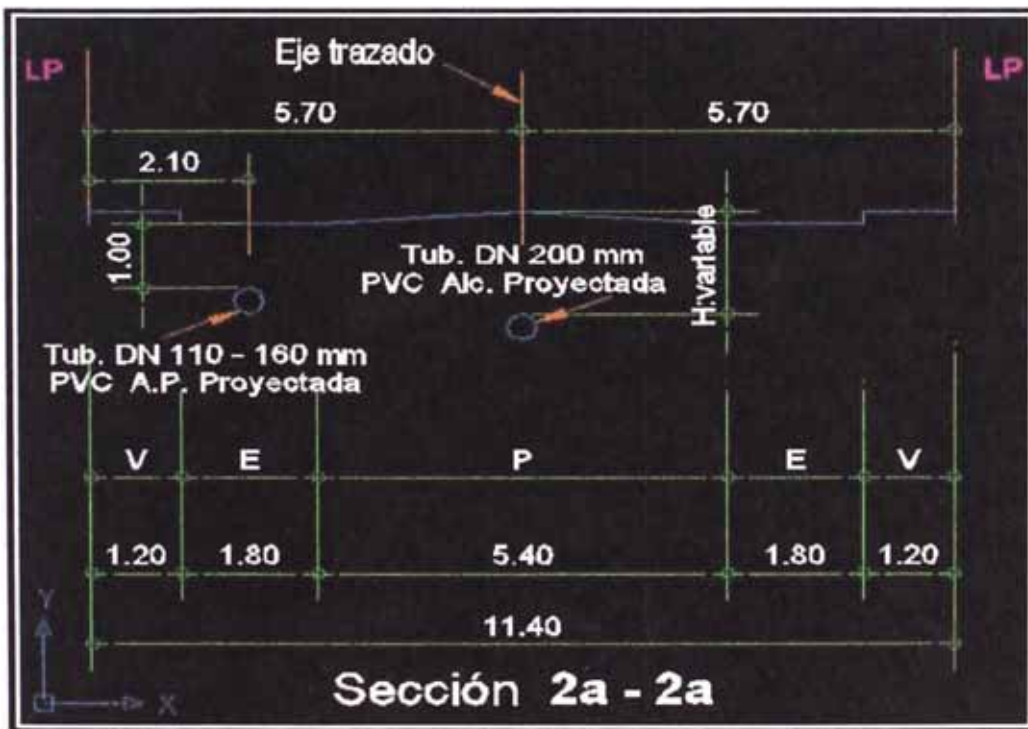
Sección del sistema de agua potable y alcantarillado empleado en el proyecto (Fuente: Proyecto Villa Club 05).
